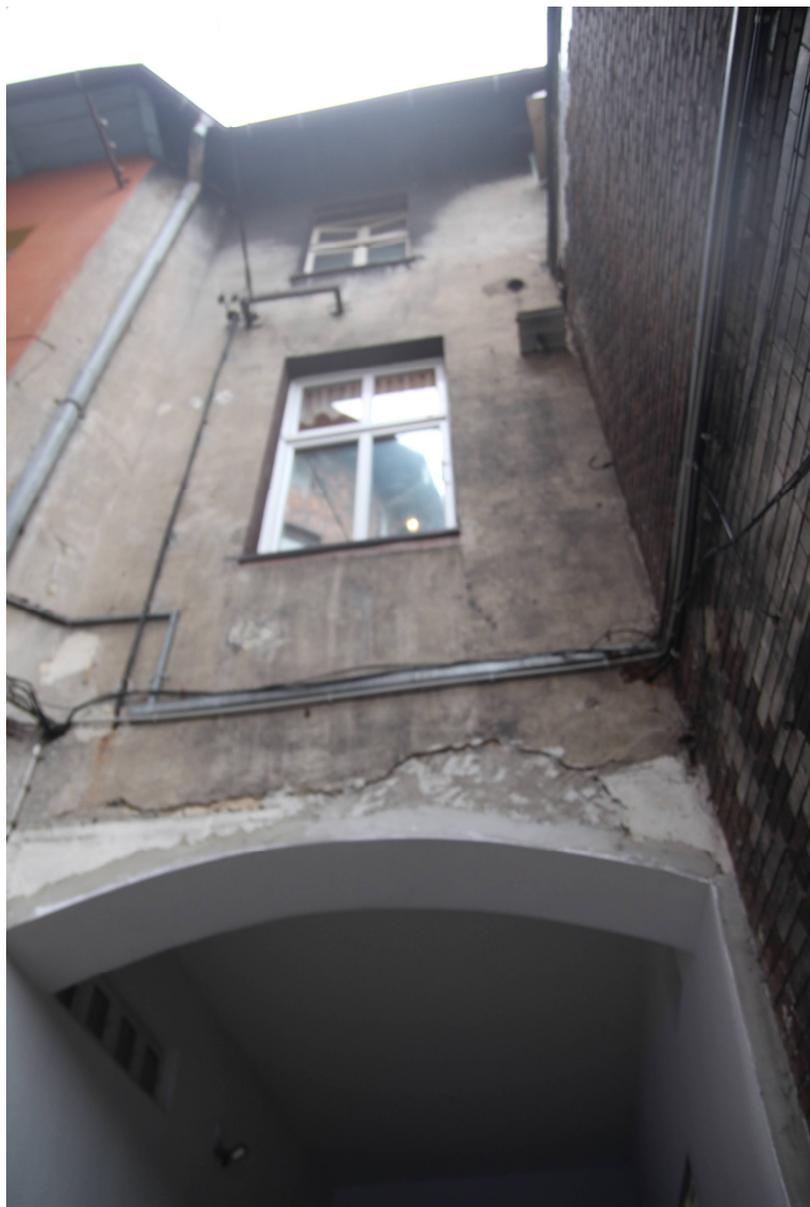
Widok elewacji południowo-wschodniej budynku przy ul. Dworcowej 18 w Bytomiu – elewacja frontowa [1.3.].
